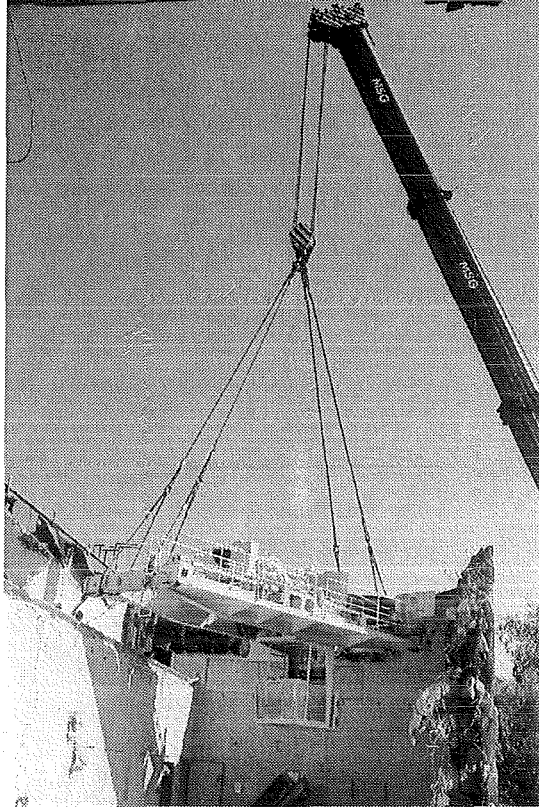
Herausheben des Brückenkrans aus dem Lagerbeckengebäude
